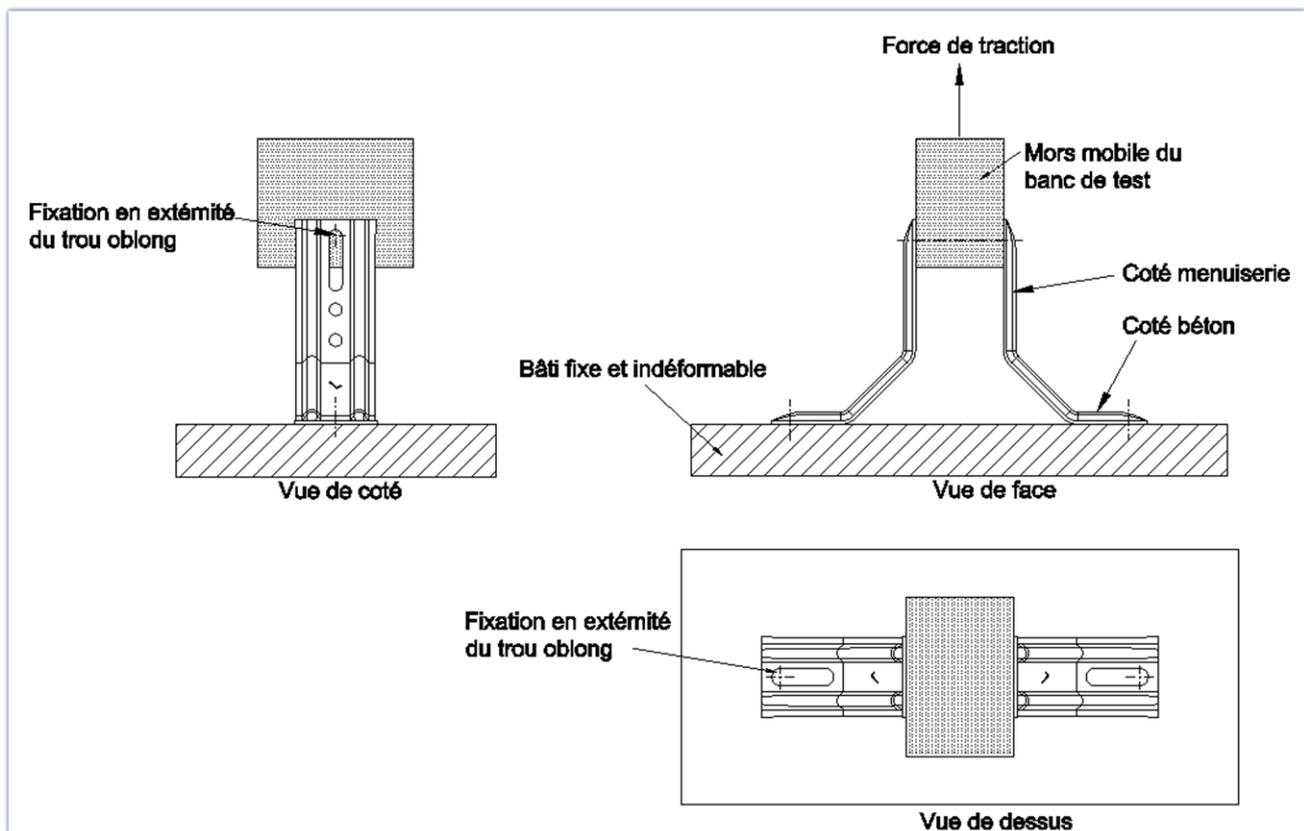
Schéma du montage pour l'essai en traction de pattes de fixation
